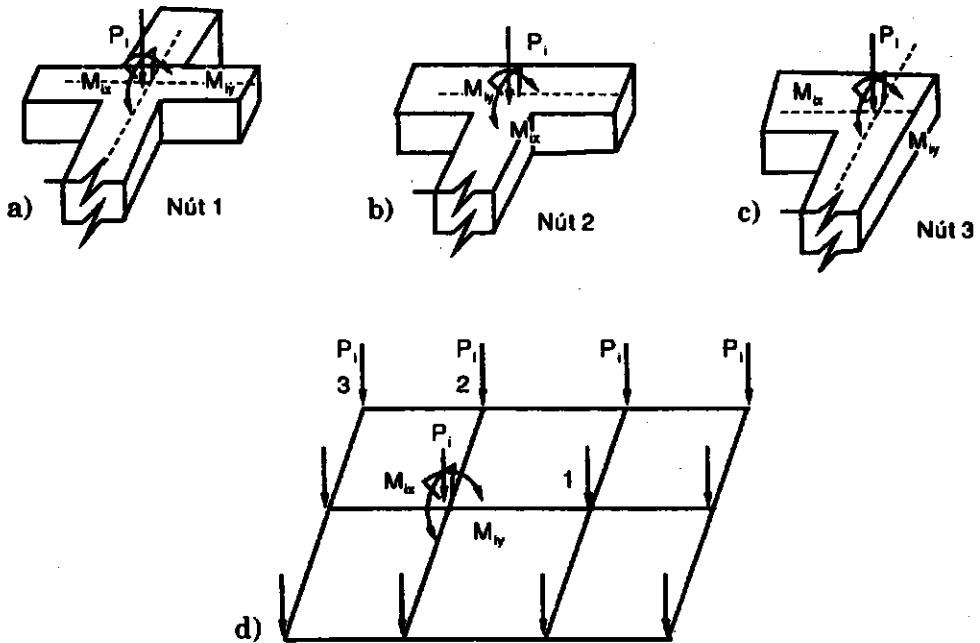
Sơ đồ cấu tạo móng băng giao nhau
